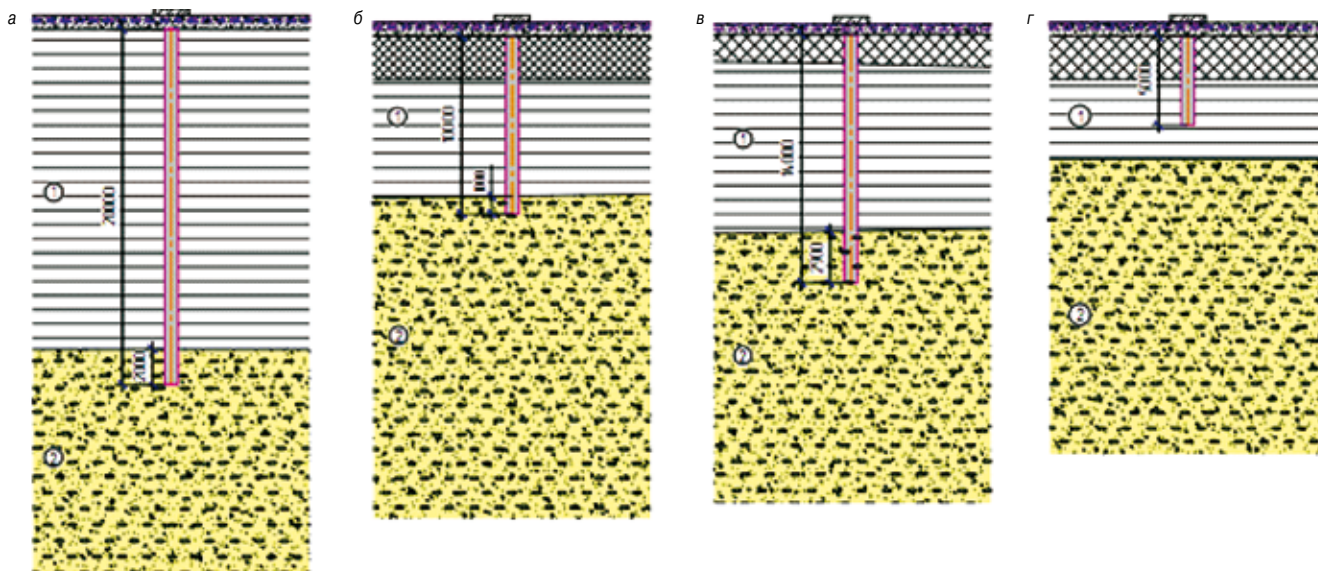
Схемы укрепления грунта: а – схема № 1: грунтоцементные колонны устроены по квадратной сетке с шагом 1400×1400 мм (длина колонн 20 м, заглубление в песчаные и крупнообломочные грунты); б – схема № 2: грунтоцементные колонны устроены по квадратной сетке с шагом 1750×1750 мм (длина колонн 10 м, заглубление в песчаные и крупнообломочные грунты); в – схема № 3: грунтоцементные колонны устроены по квадратной сетке с шагом 1750×1750 мм (длина колонн 14 м, заглубление в песчаные и крупнообломочные грунты); г – схема № 4: грунтоцементные колонны устроены по квадратной сетке с шагом 2000×2000 мм (длина колонн 5 м, без заглубления в песчаные и крупнообломочные грунты)
